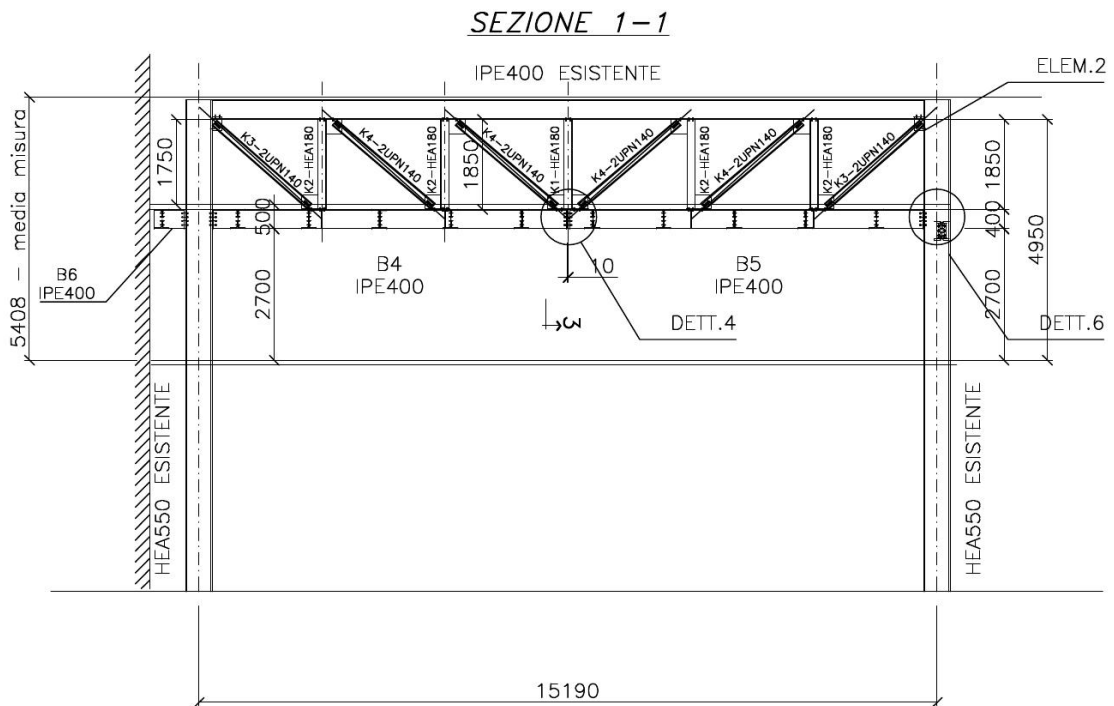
Particolare di A.2007.a.sa.T01 - Progetto della struttura - Prospetto Ovest
